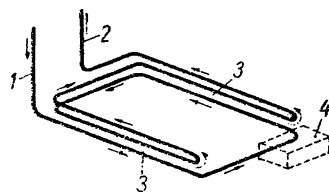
Serpentină de încălzire în focarul mașinii de gătit :
